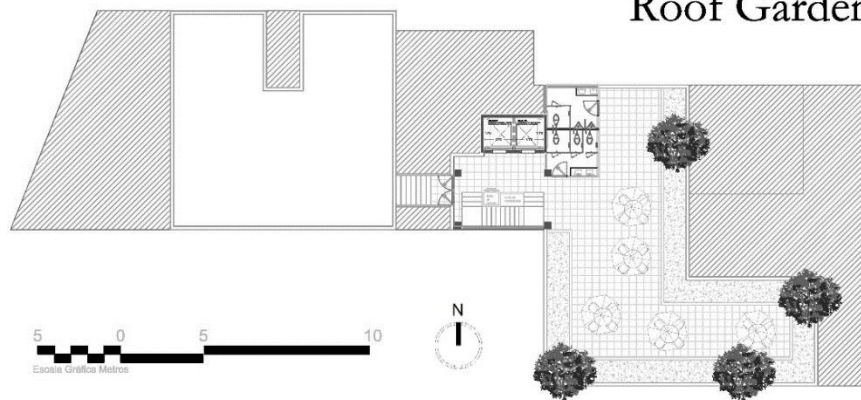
2/2 Plantas tipo del proyecto conceptual.
